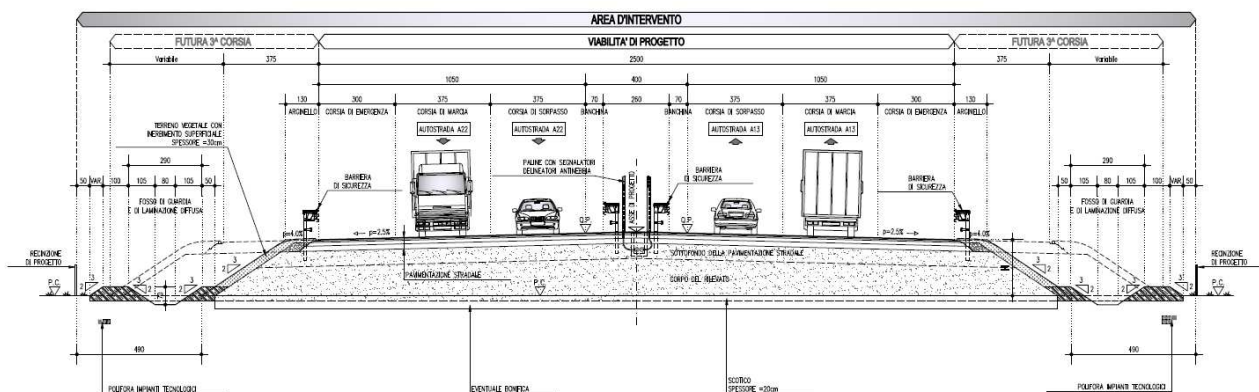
SEZIONE TIPO ASSE AUTOSTRADALE IN RETTIFILO (RILEVATI HS7M)
